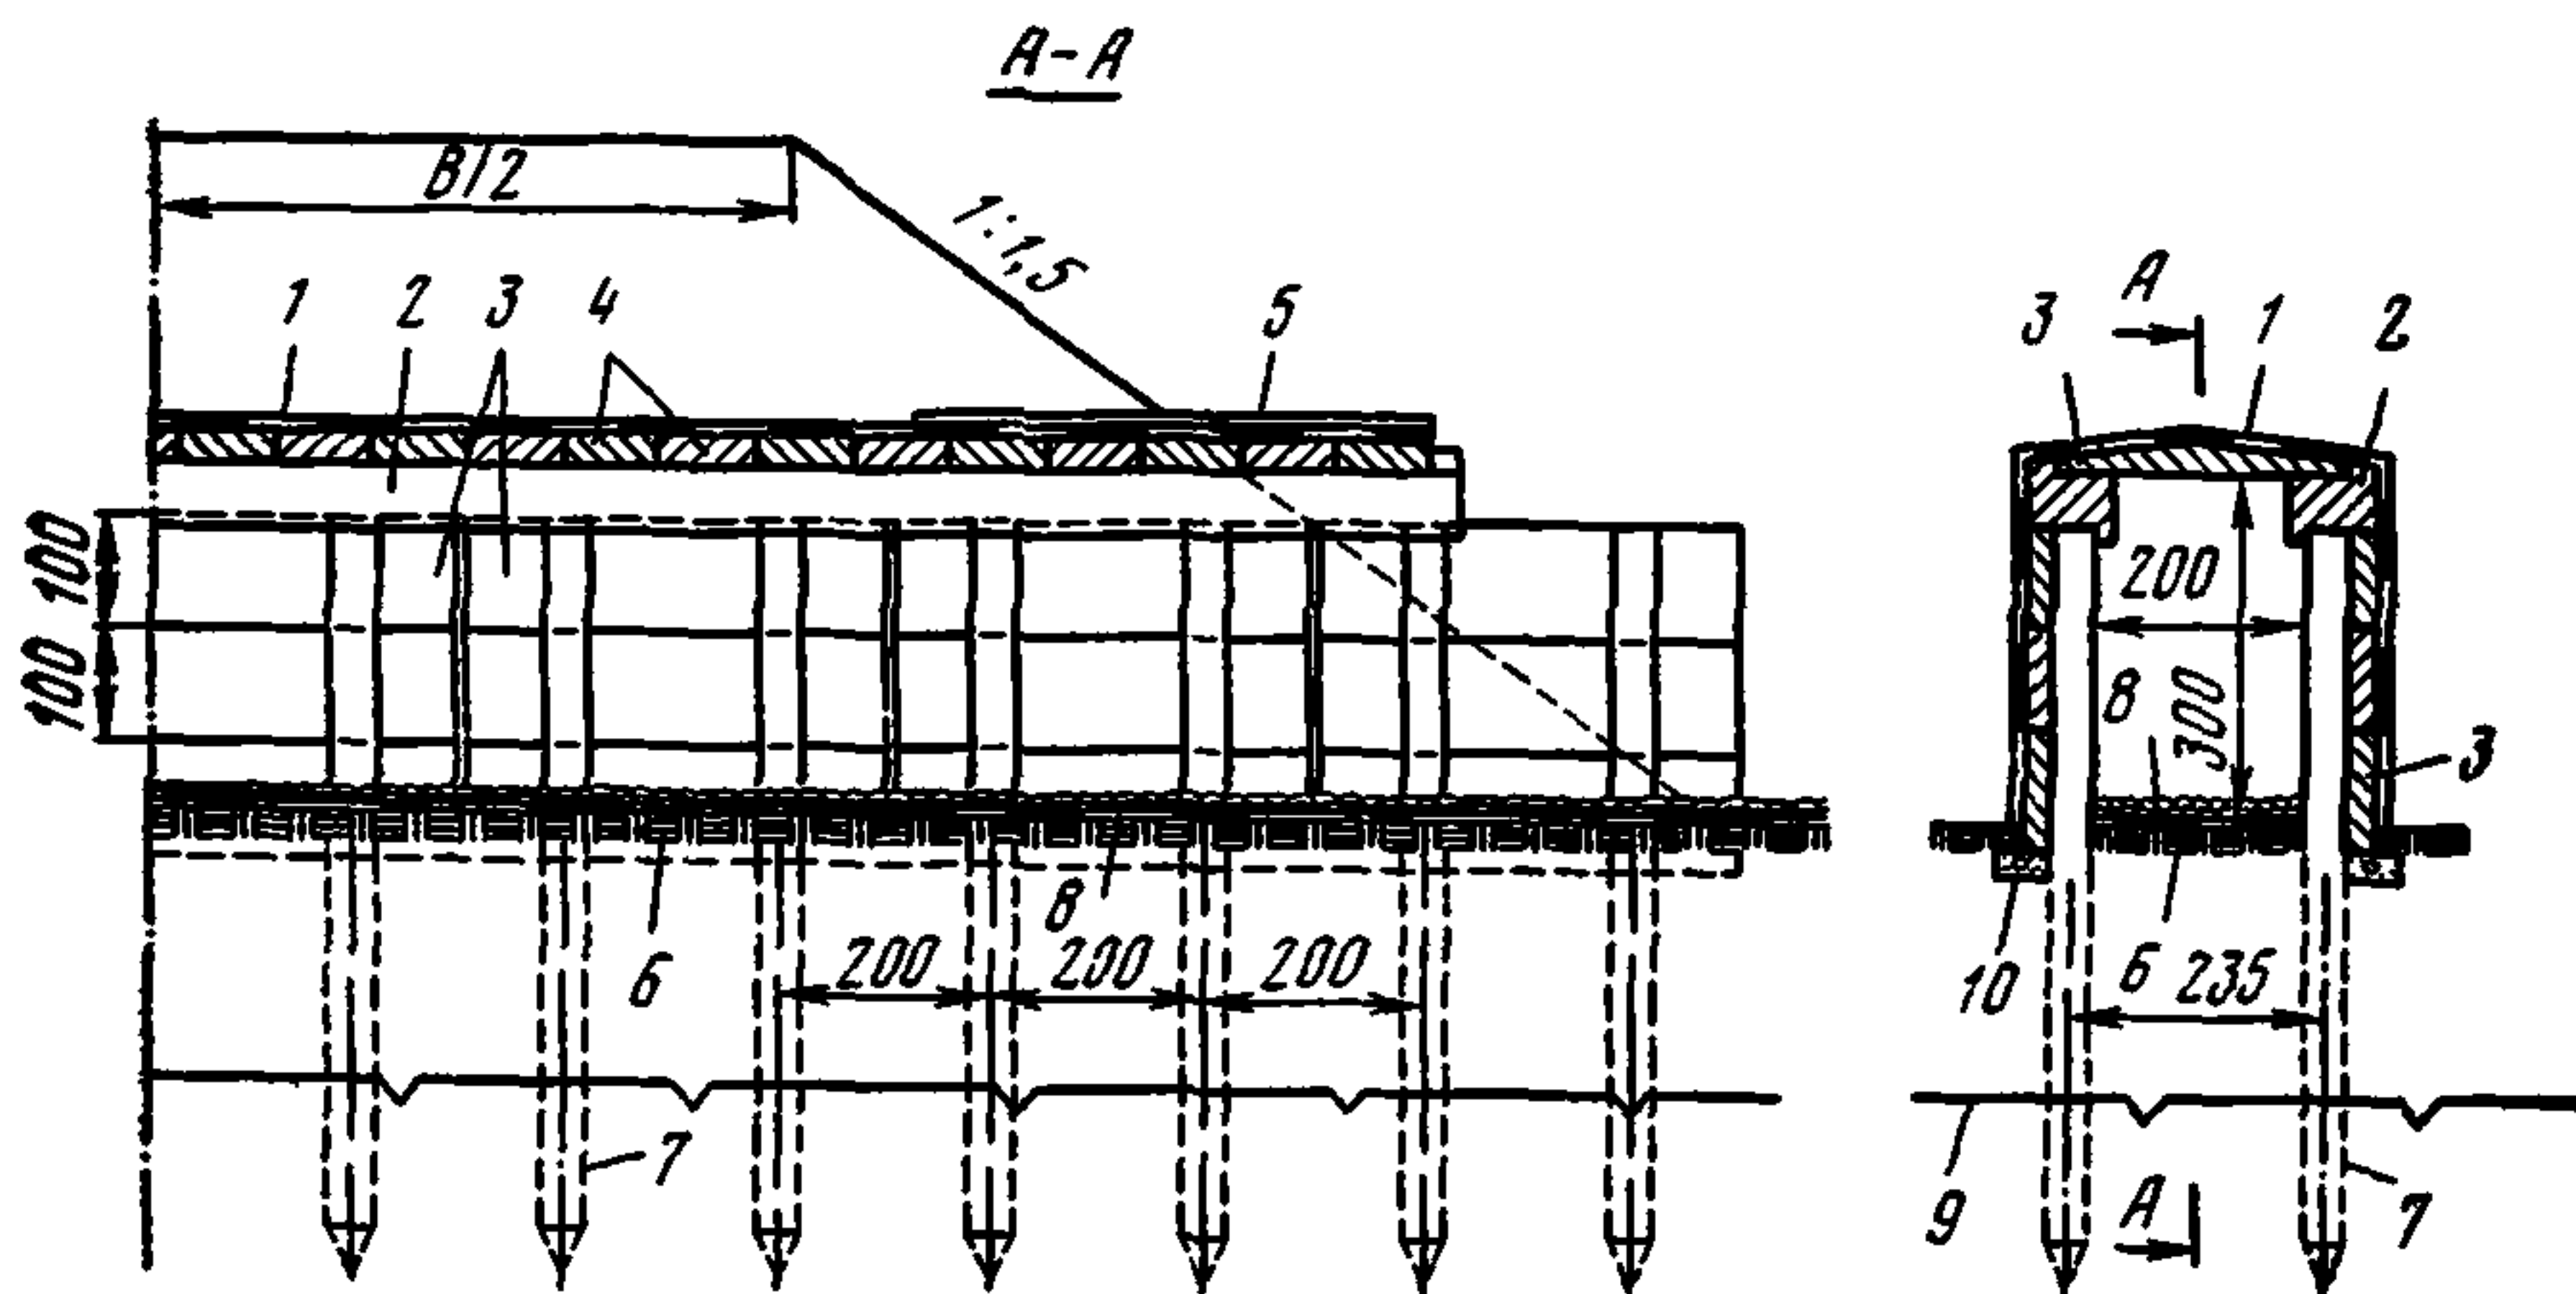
Конструкция прямоугольной железобетонной свайно-щитовой трубы Ленгипротранса:
